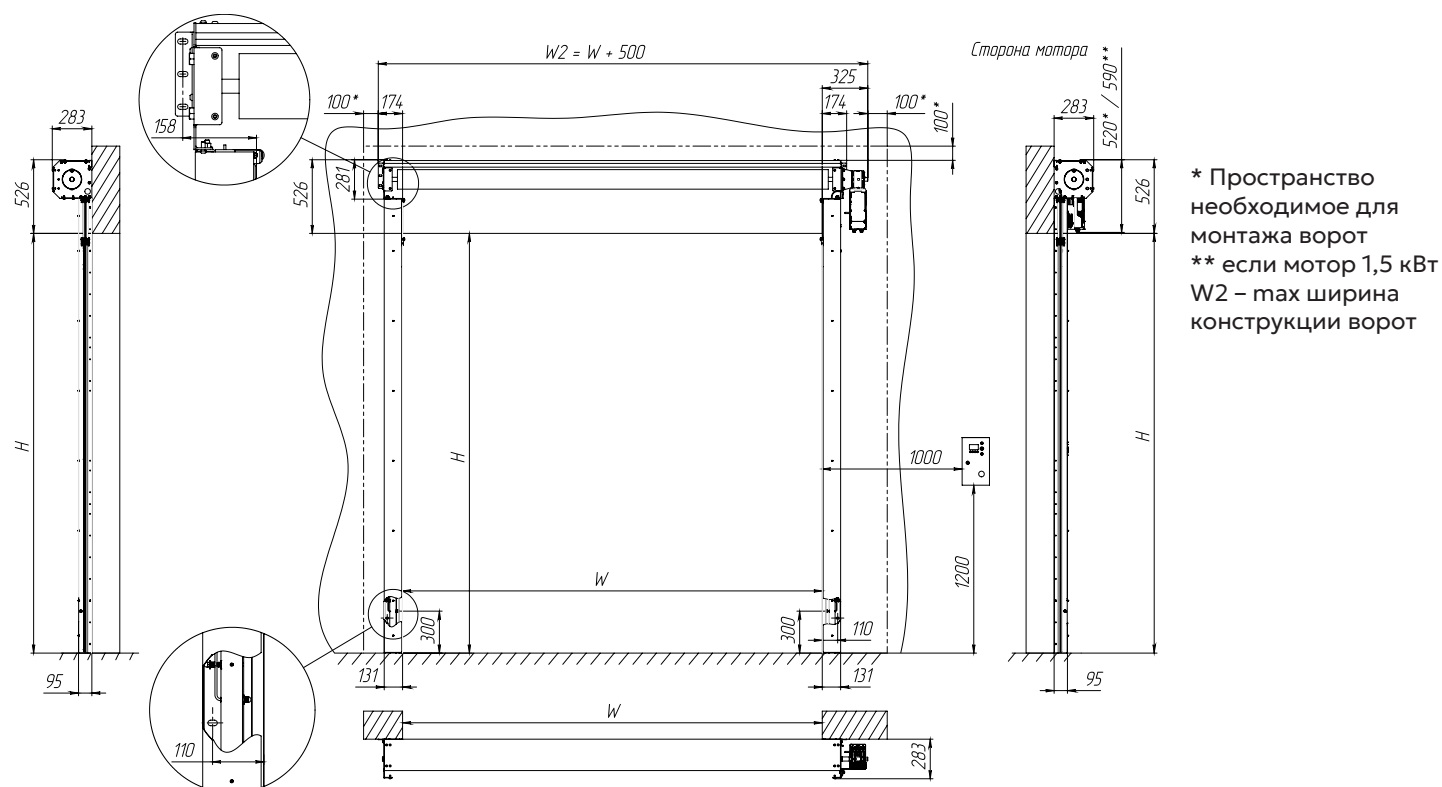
Установочные размеры скоростных ворот Rotor Zip Pro без защитных коробов
